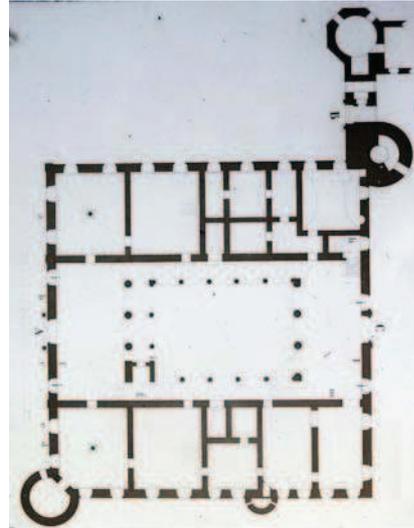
Grundriss Schloss Porcia EG
